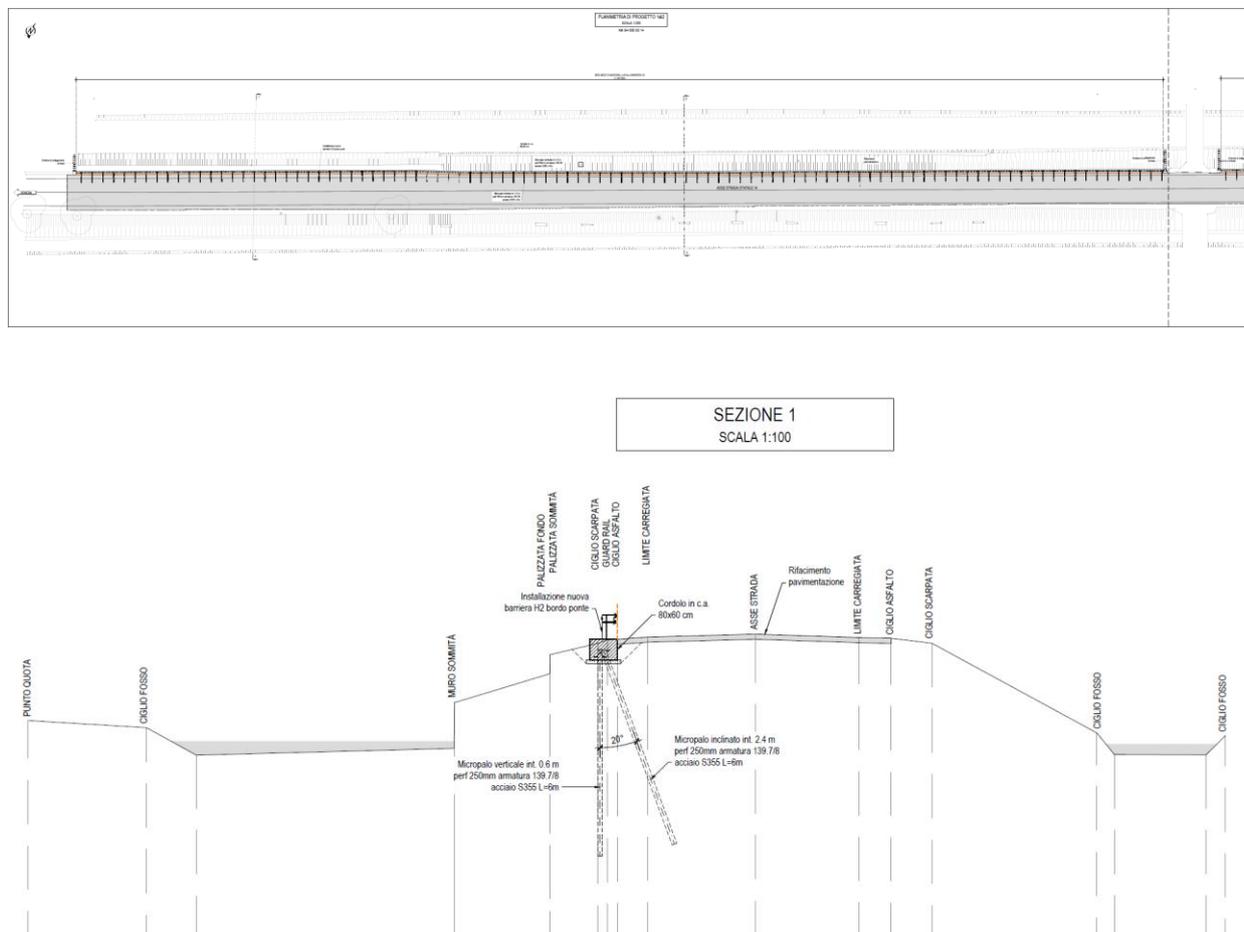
Intervento km. 54 +550 – stralcio planimetrico e sezione trasversale
